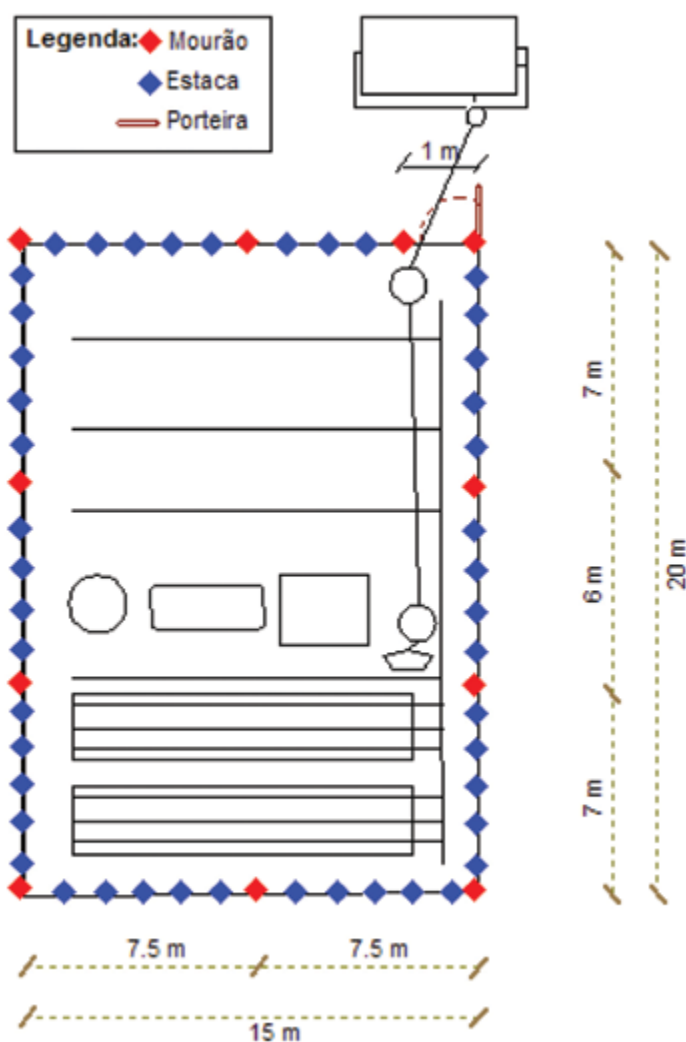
Planta baixa da disposição de mourões, estacas e porteira no SBF.
